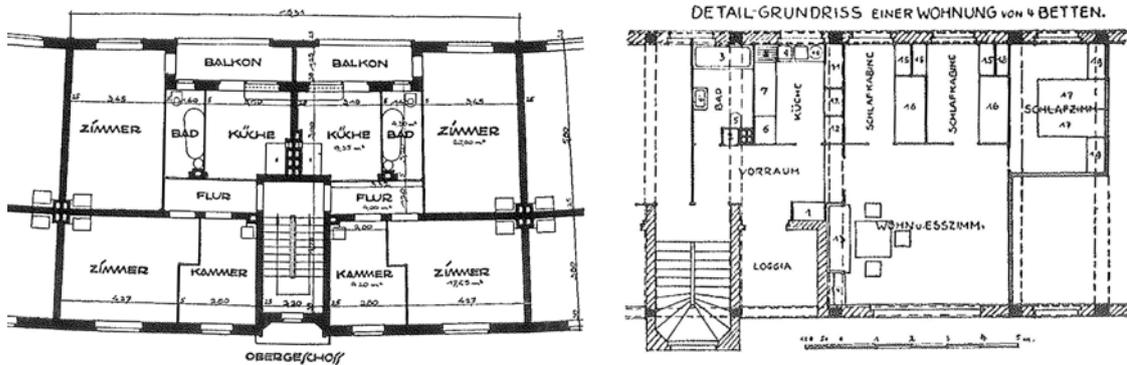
Grundrissvarianten der Hufeisensiedlung
